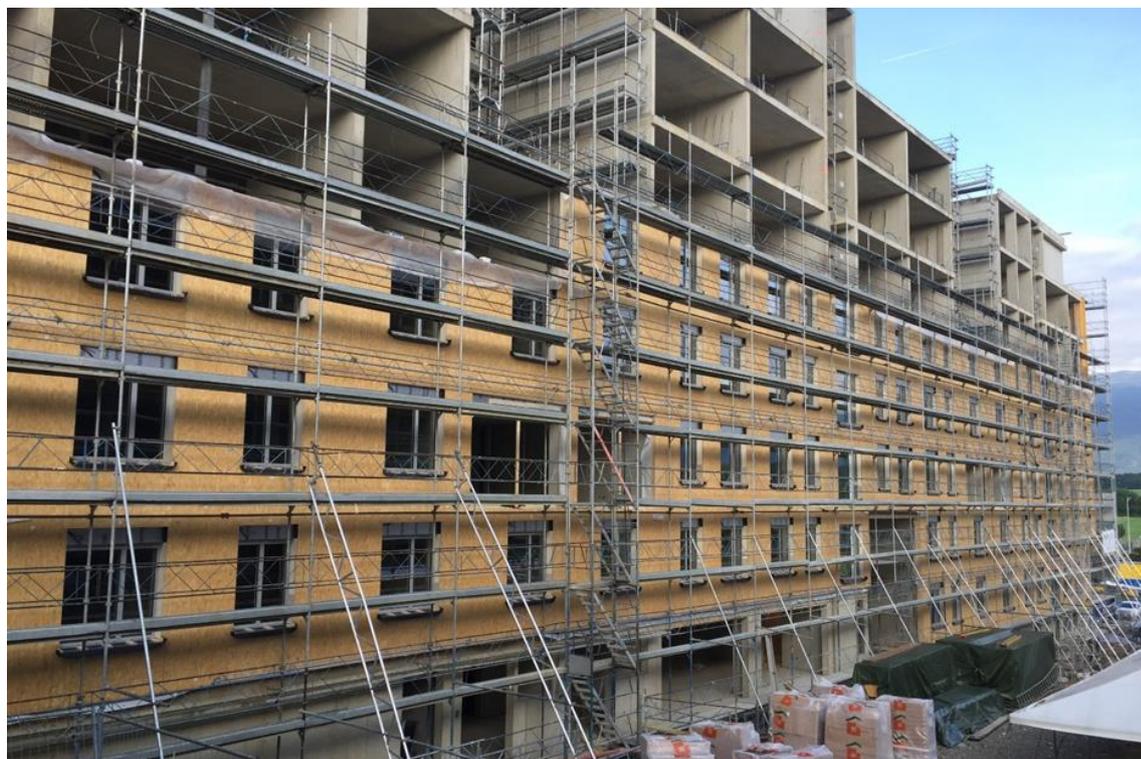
Fassadeneinbau beim Projekt Les Vergers in Meyrin/Genf
